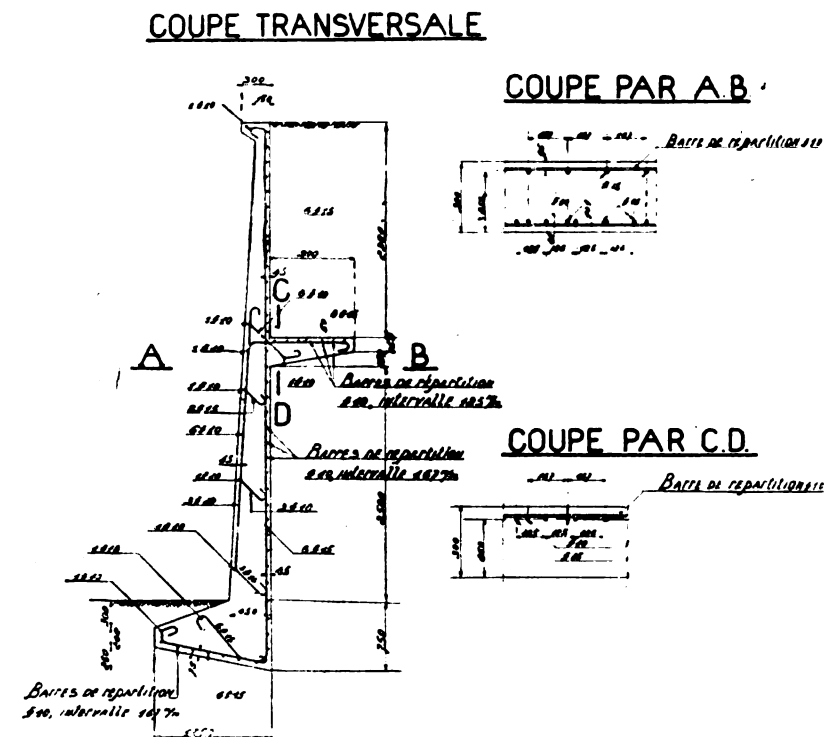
Muro di sostegno in calcestruzzo di cemento leggermente armato (1° tipo, con mensola di equilibrio).
